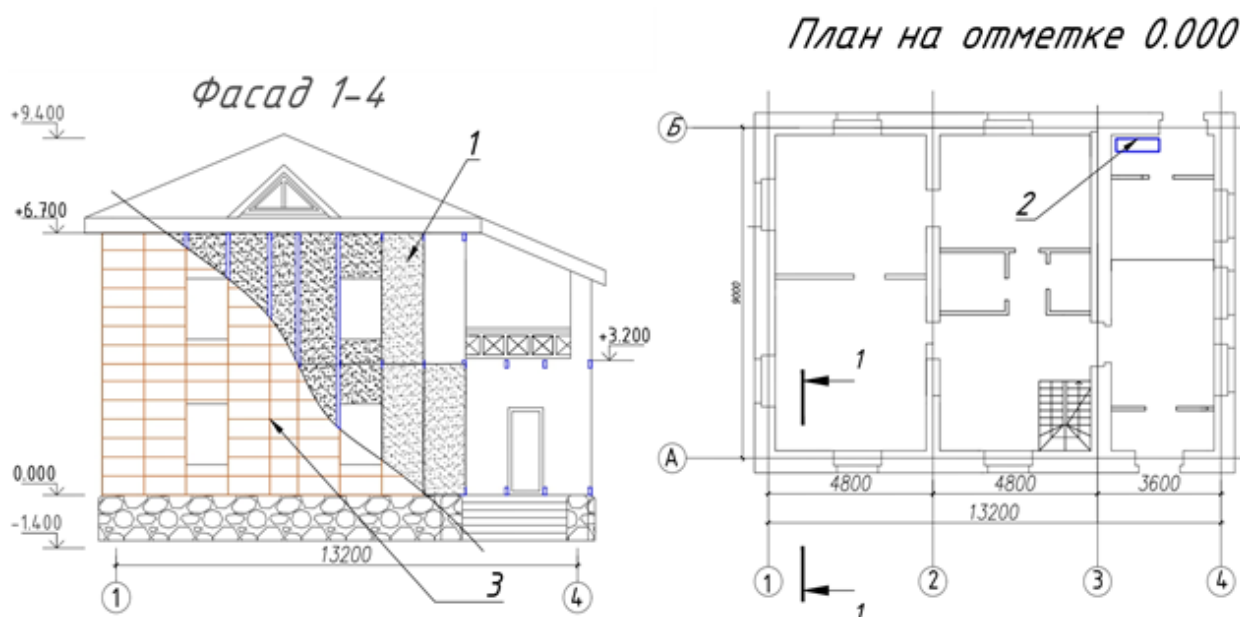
Вакуумная теплоизоляция и звукоизоляция индивидуального жилого дома: 1 – вакуумные теплоизоляционные и звукоизоляционные панели; 2 – вакуумный распределительный узел; 3 – защитная оболочка фасада
